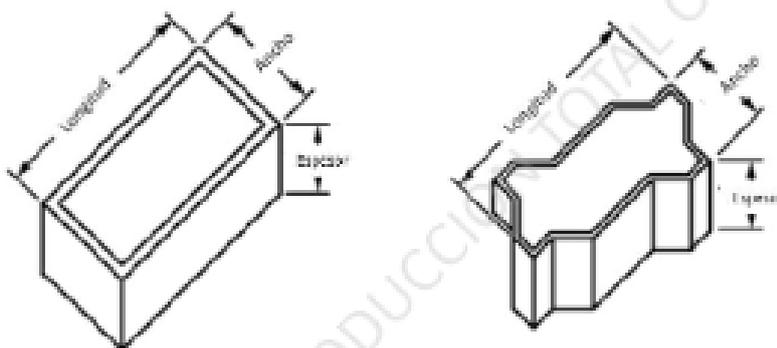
Longitud, ancho y espesor de los adoquines para pavimentos.
